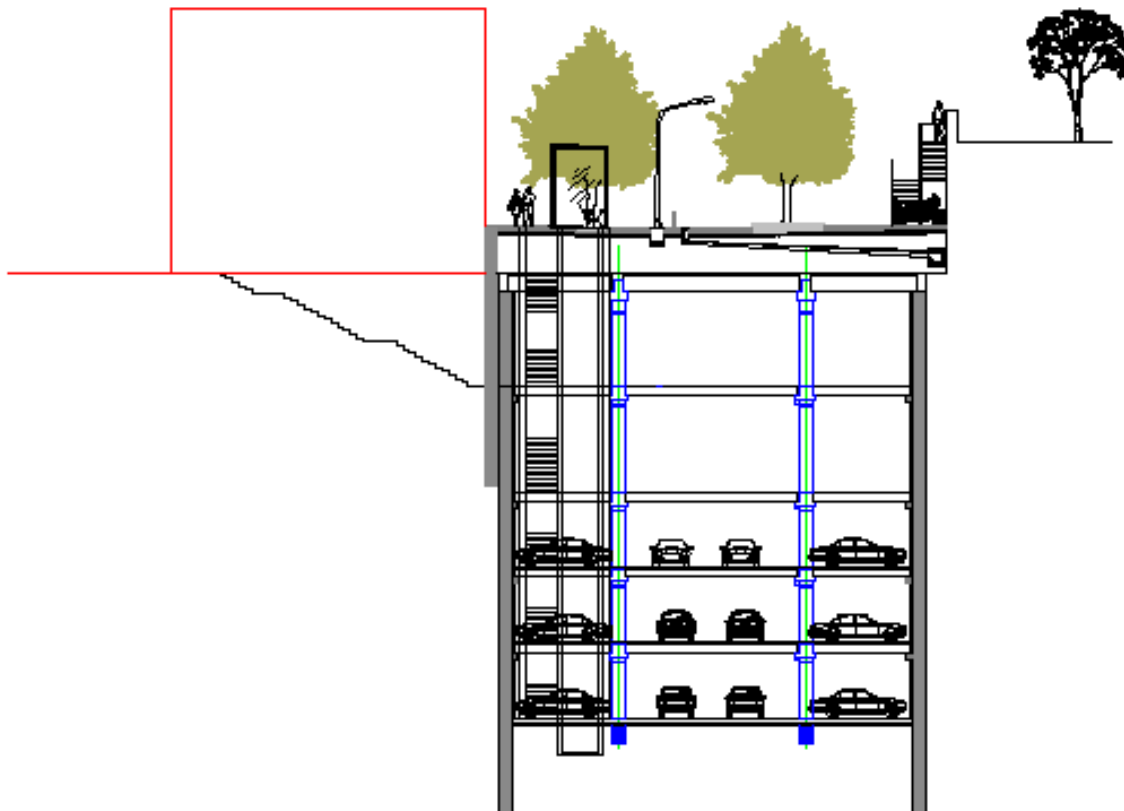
Ampliación de las instalaciones bajo el aparcamiento actual paralelo a la C/Sor Eulalia d'Anzizu
